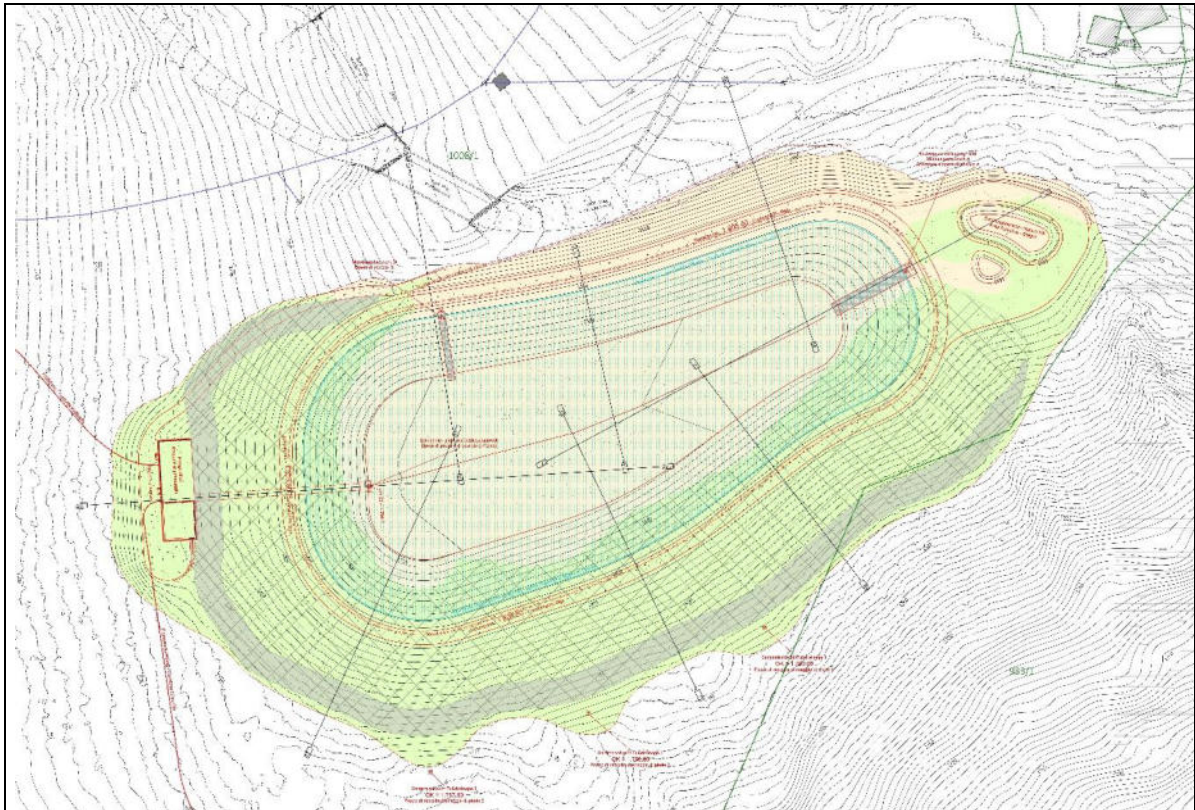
Auszug aus dem Projekt - Lageplan / Stralcio da progetto - planimetria
